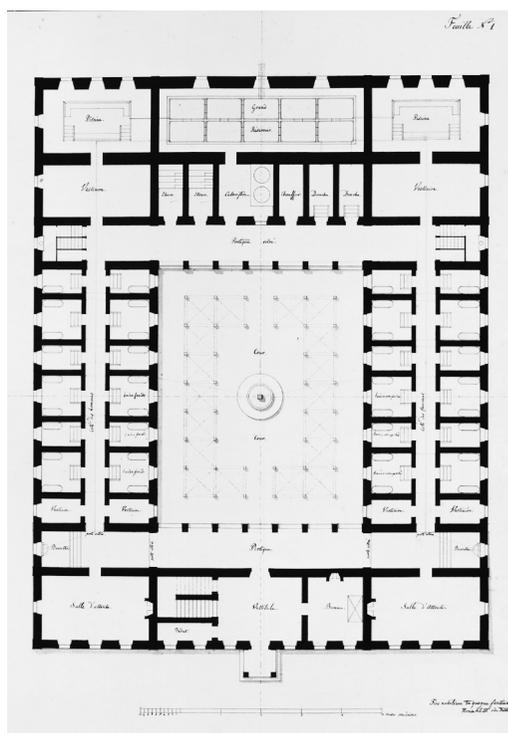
Lavey, projet de concours pour les bains d'Henri Fraisse, plan du rez-de-chaussée, 1835 (ACV).
